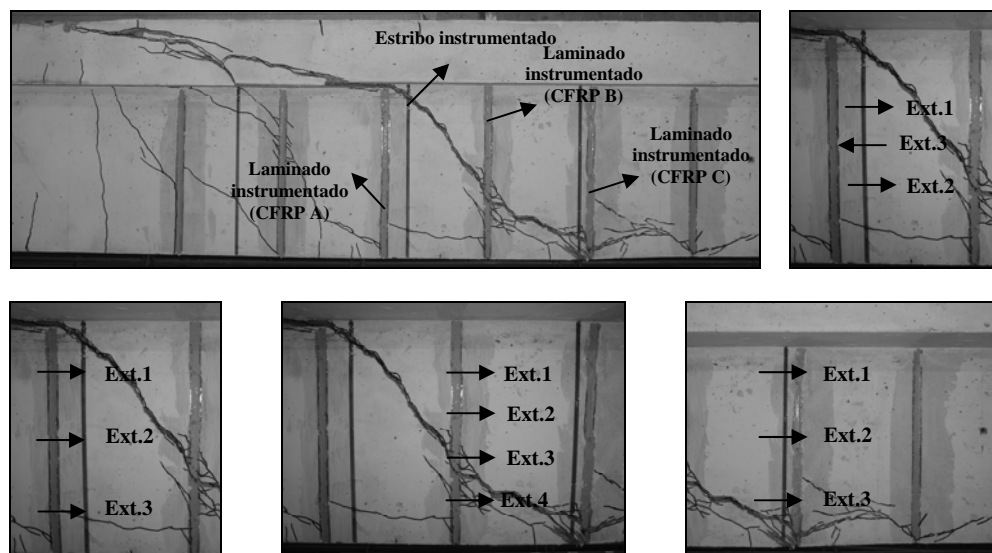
Localização dos extensómetros no laminado e estribo instrumentados da viga 3S-6LV-D.
